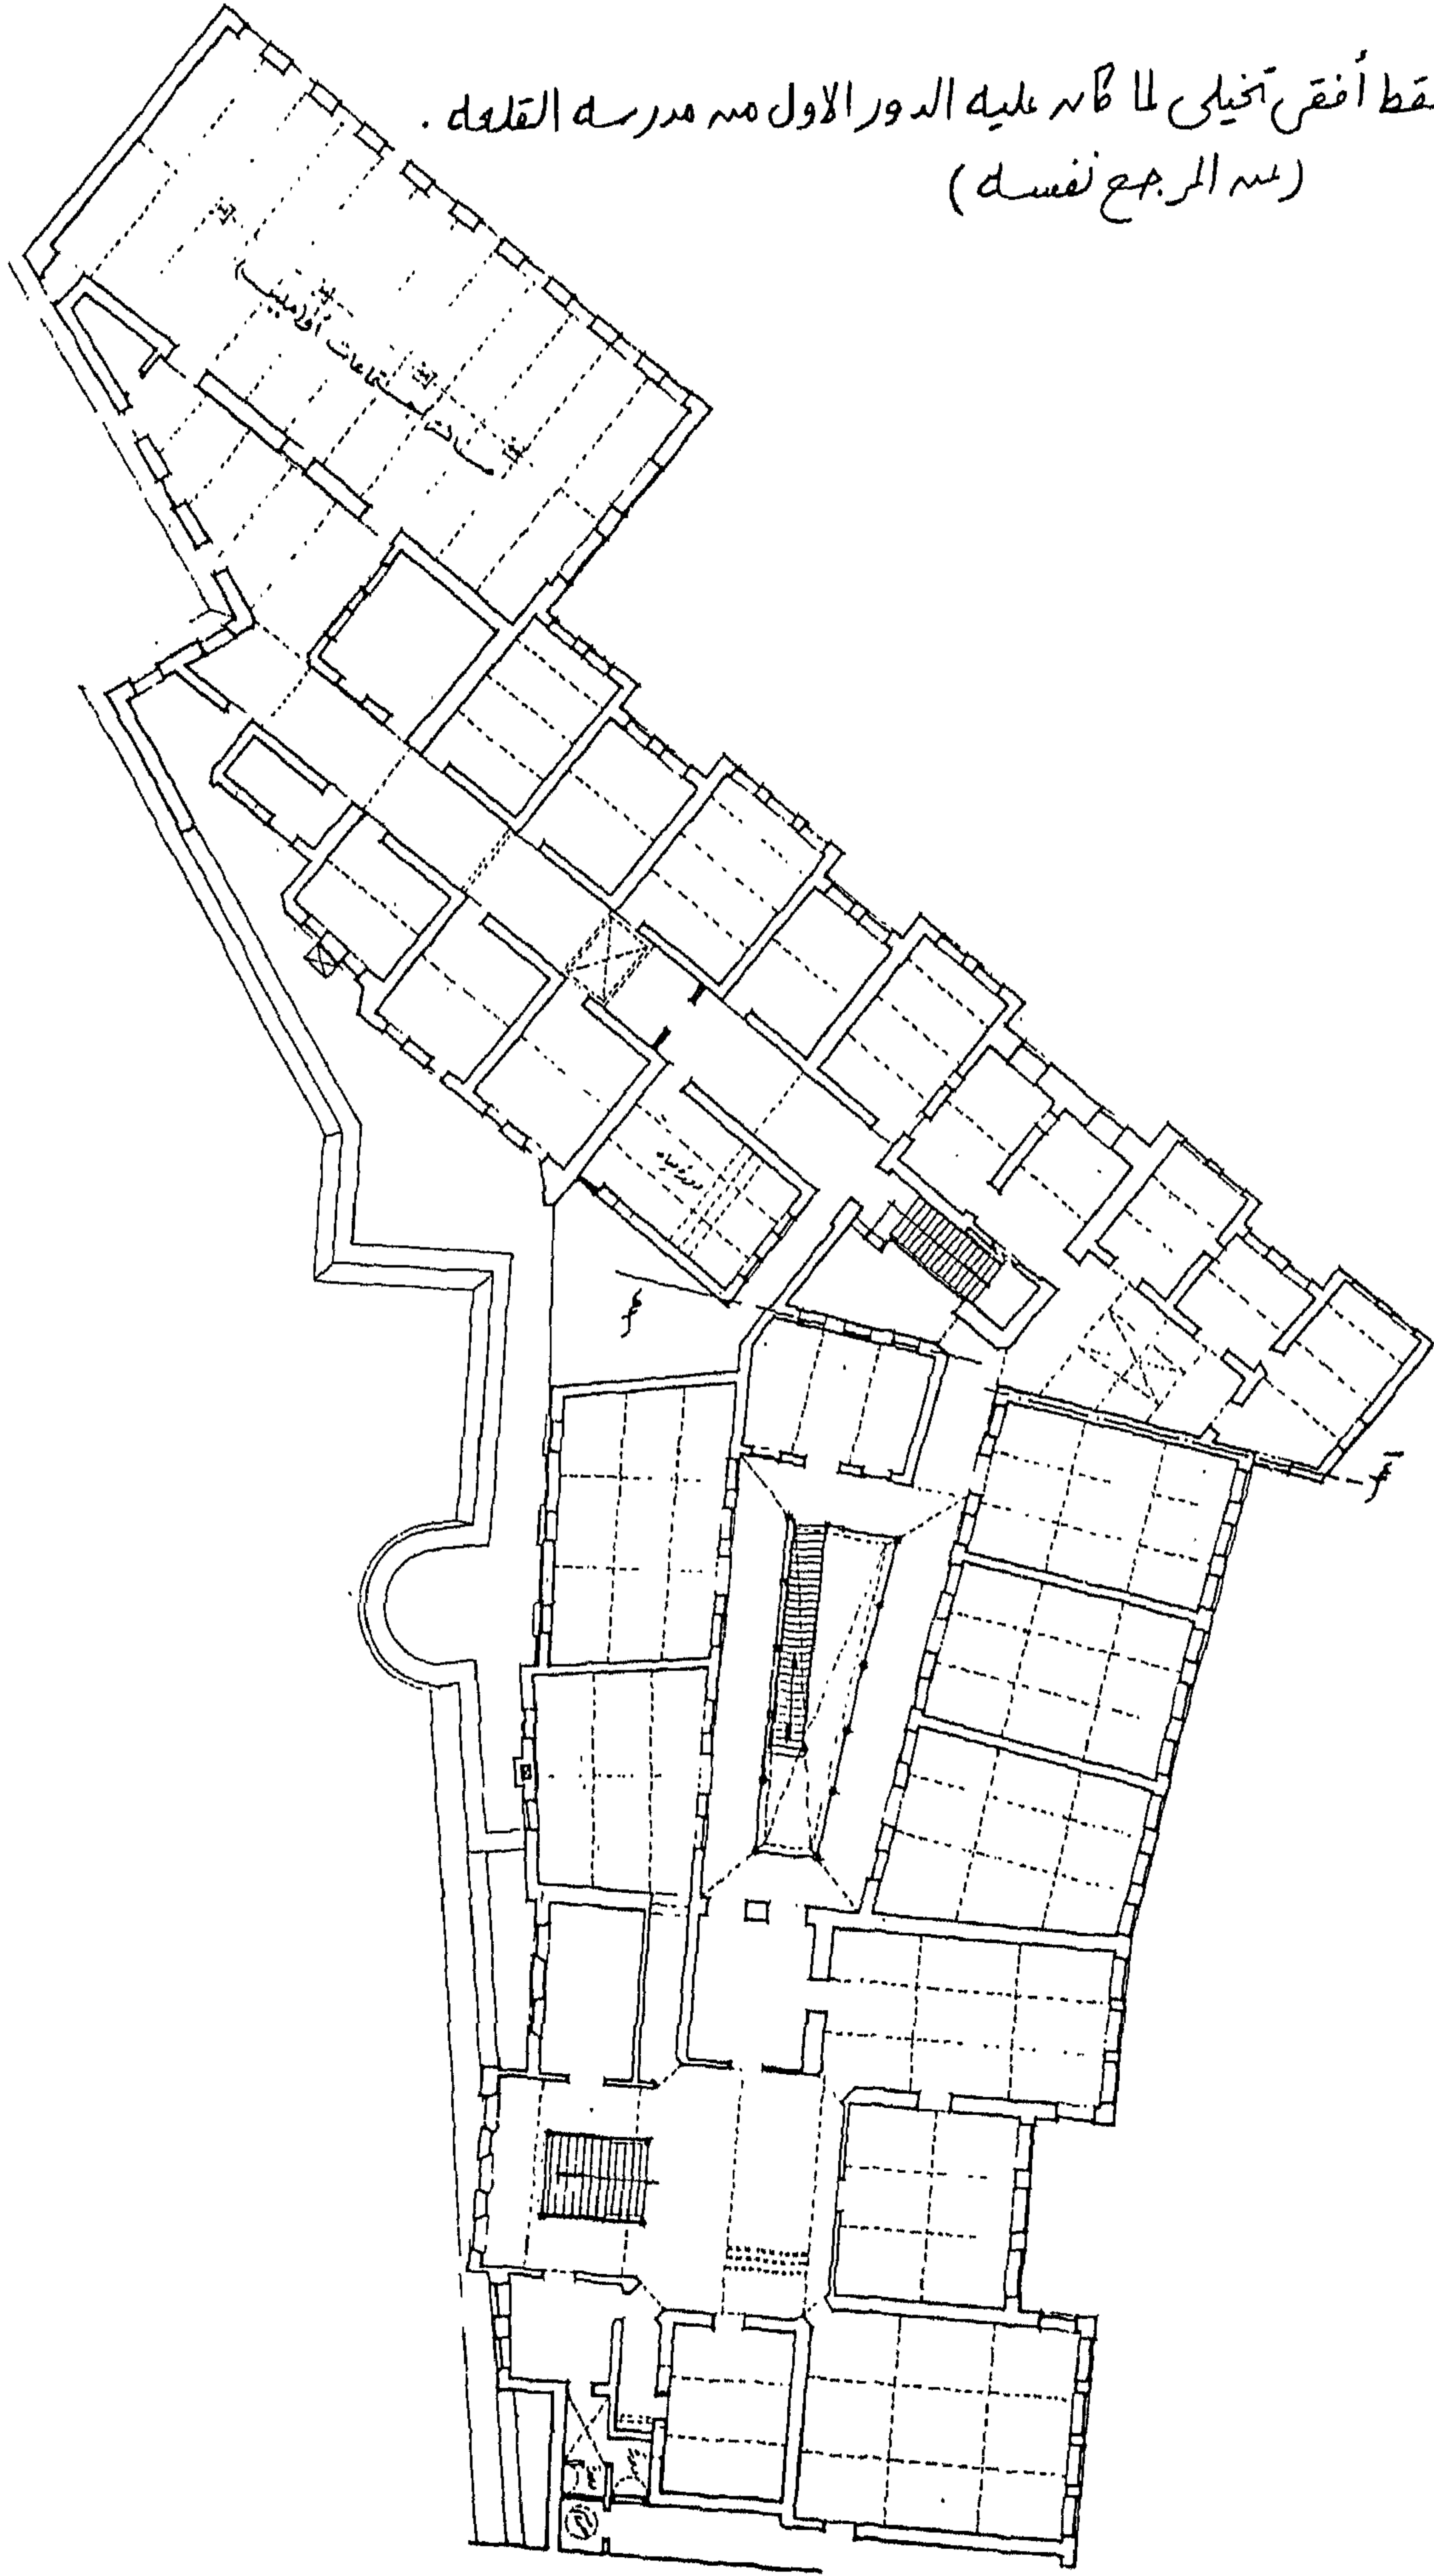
مستط أفقي للـ دور الأول من مدرسة القلعة
